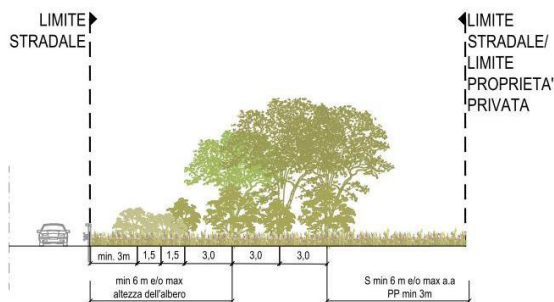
Sesto d'impianto e sezione tipologica
